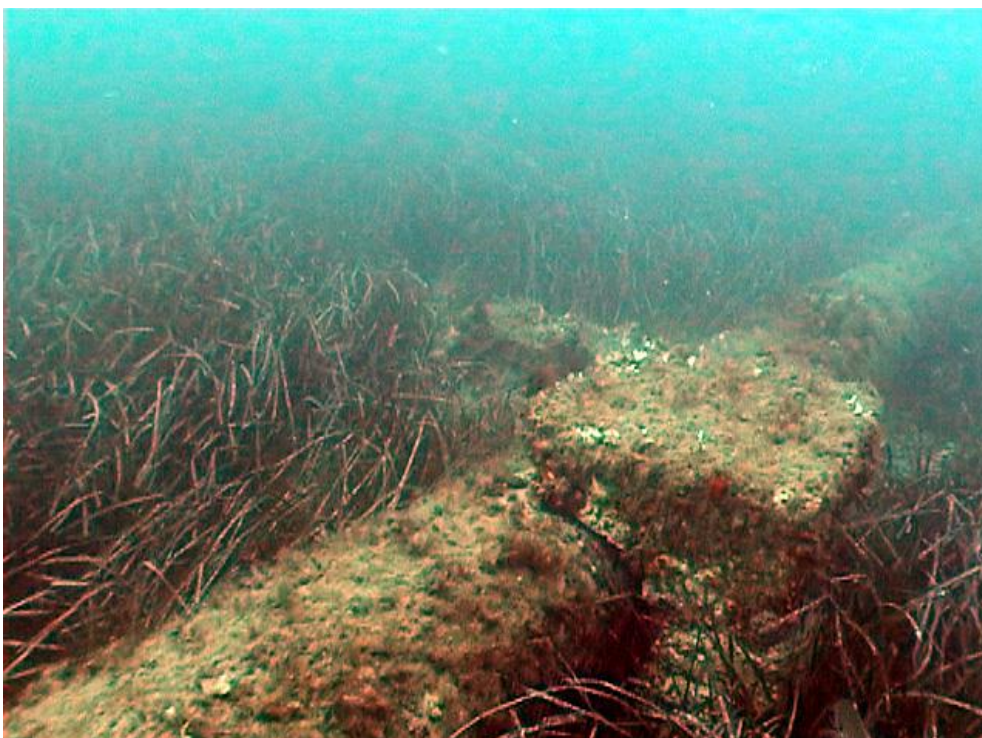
Cota -19 m. Pila de bloques y hormigón en mal estado
